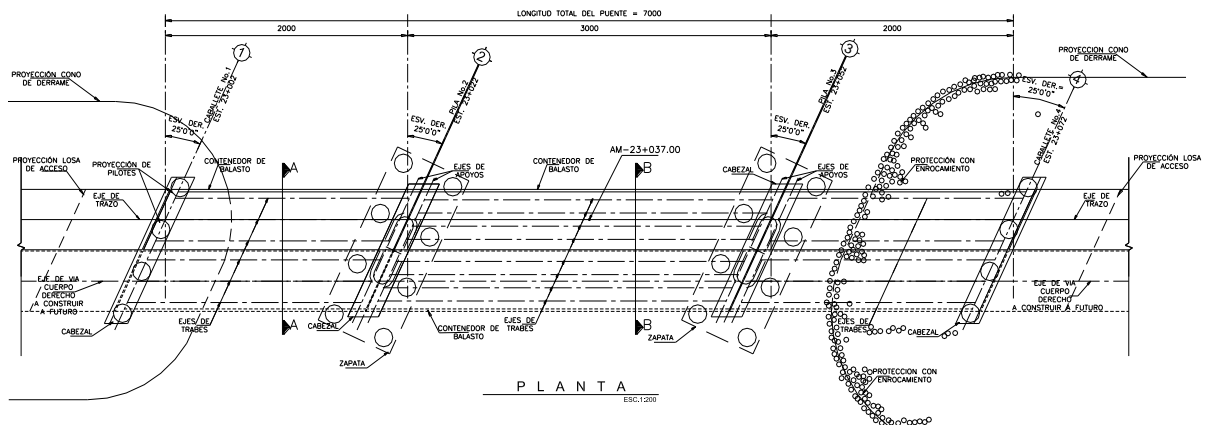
Planta de proyecto del puente las Lajas III.
